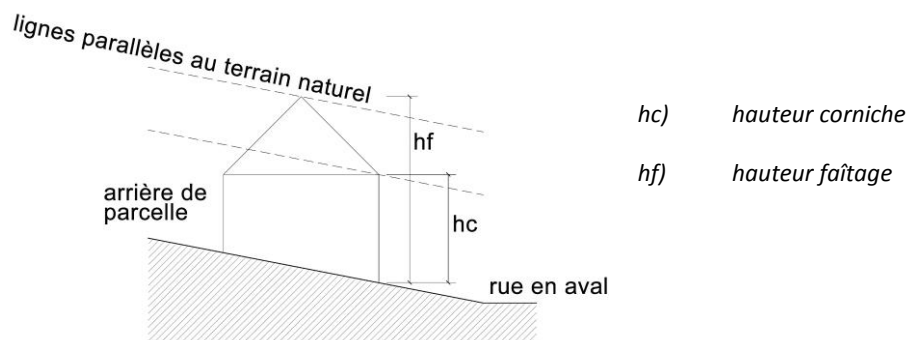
Hauteurs des constructions dans le cas du terrain en pente
